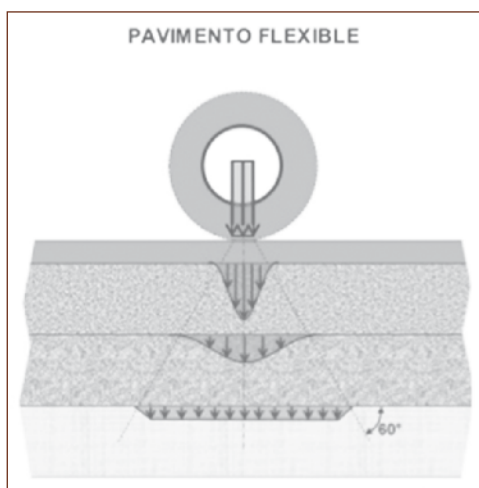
Extensión e impacto en la deformación en un pavimento flexible.
